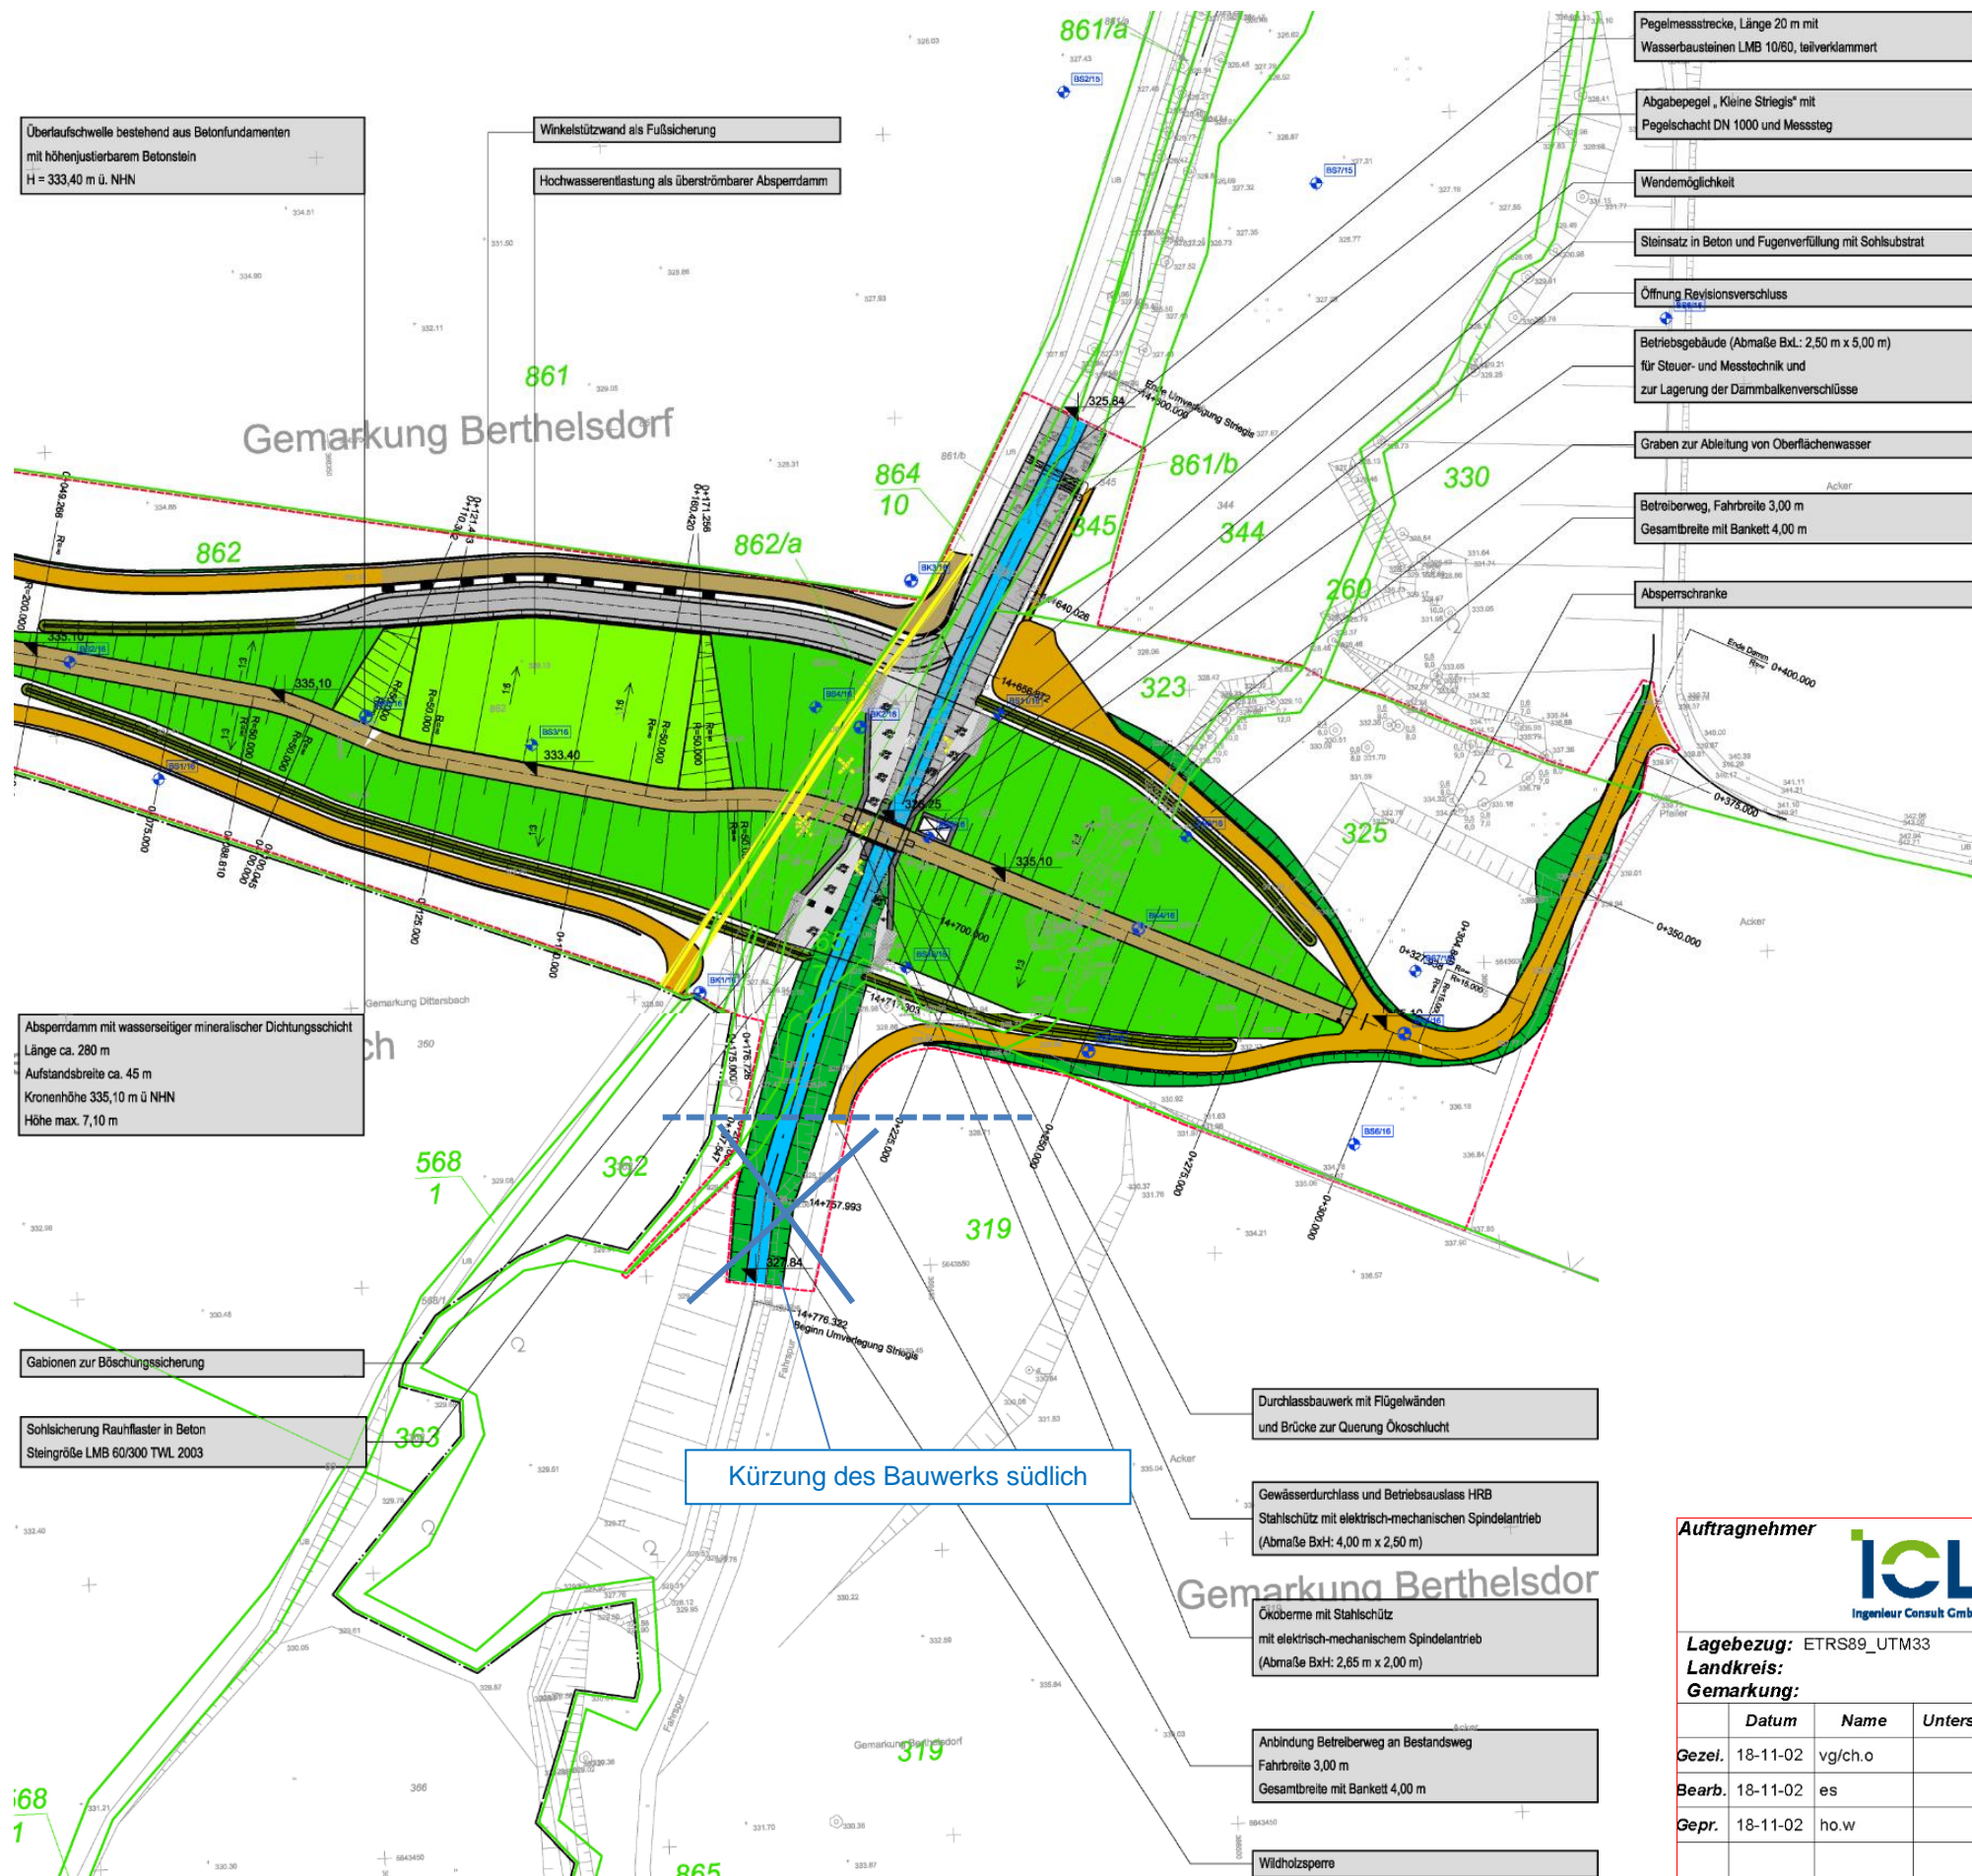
Planung Absperrdamm mit Einstauflächen, Plan Nr. 3 (ICL/ Klemm & Hensen v. 10.08.2016, DARR LA zugesandt am 08.11.2016)
